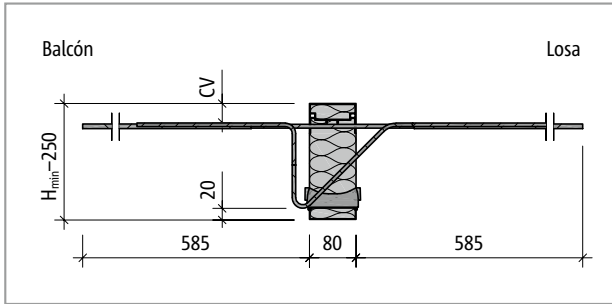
Schöck Isokorb® T tipo K-M1 hasta M4 en R0: Sección del producto
